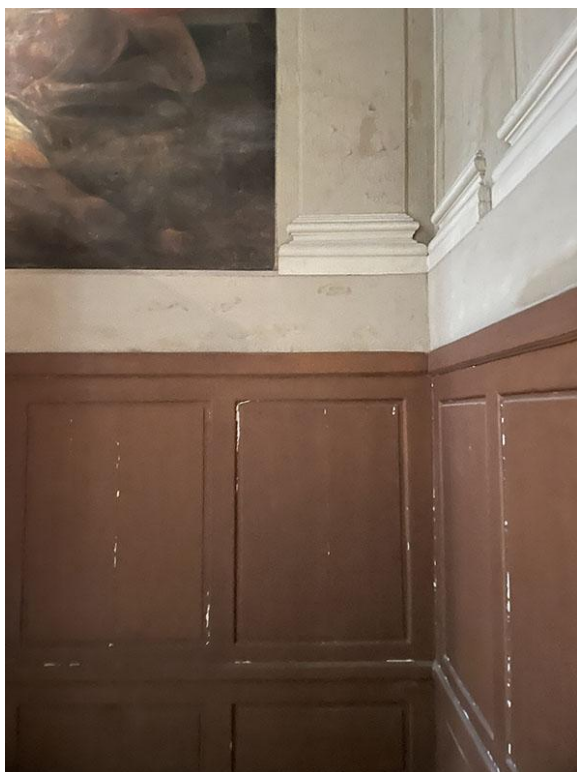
Ecaillage de la peinture et fissuration due au mouvement des panneaux sur les murs nord et est.
